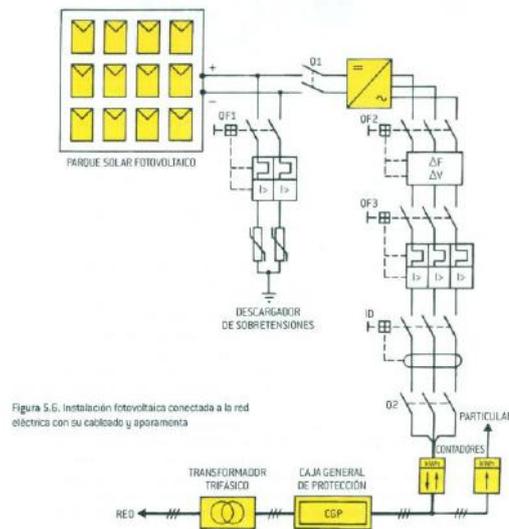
Instalación fotovoltaica conectada a la red eléctrica con su cableado y aparataje
